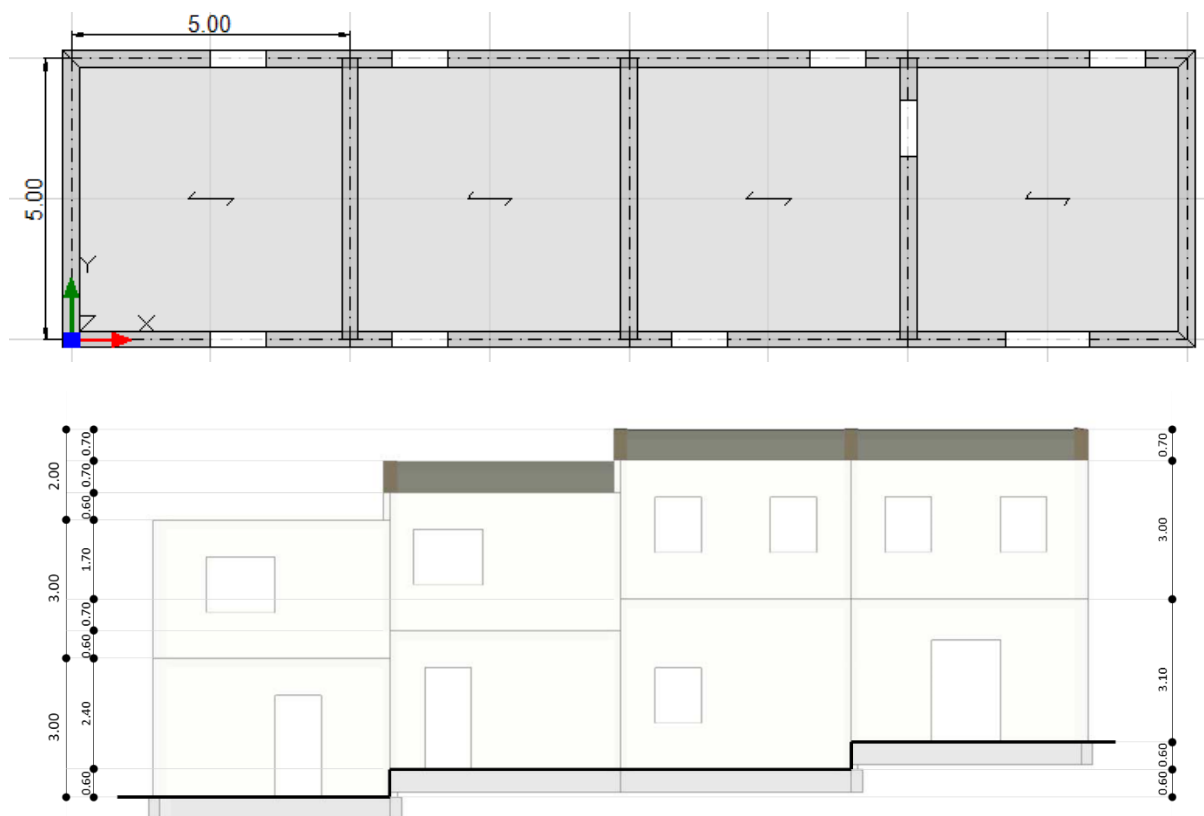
Viste in Pianta ed in Prospetto dell'Aggregato
